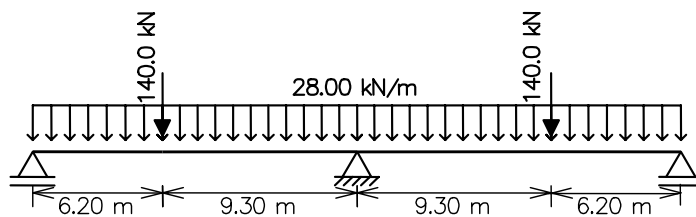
Geometria e carregamento da viga V_1 do Exemplo 1.
